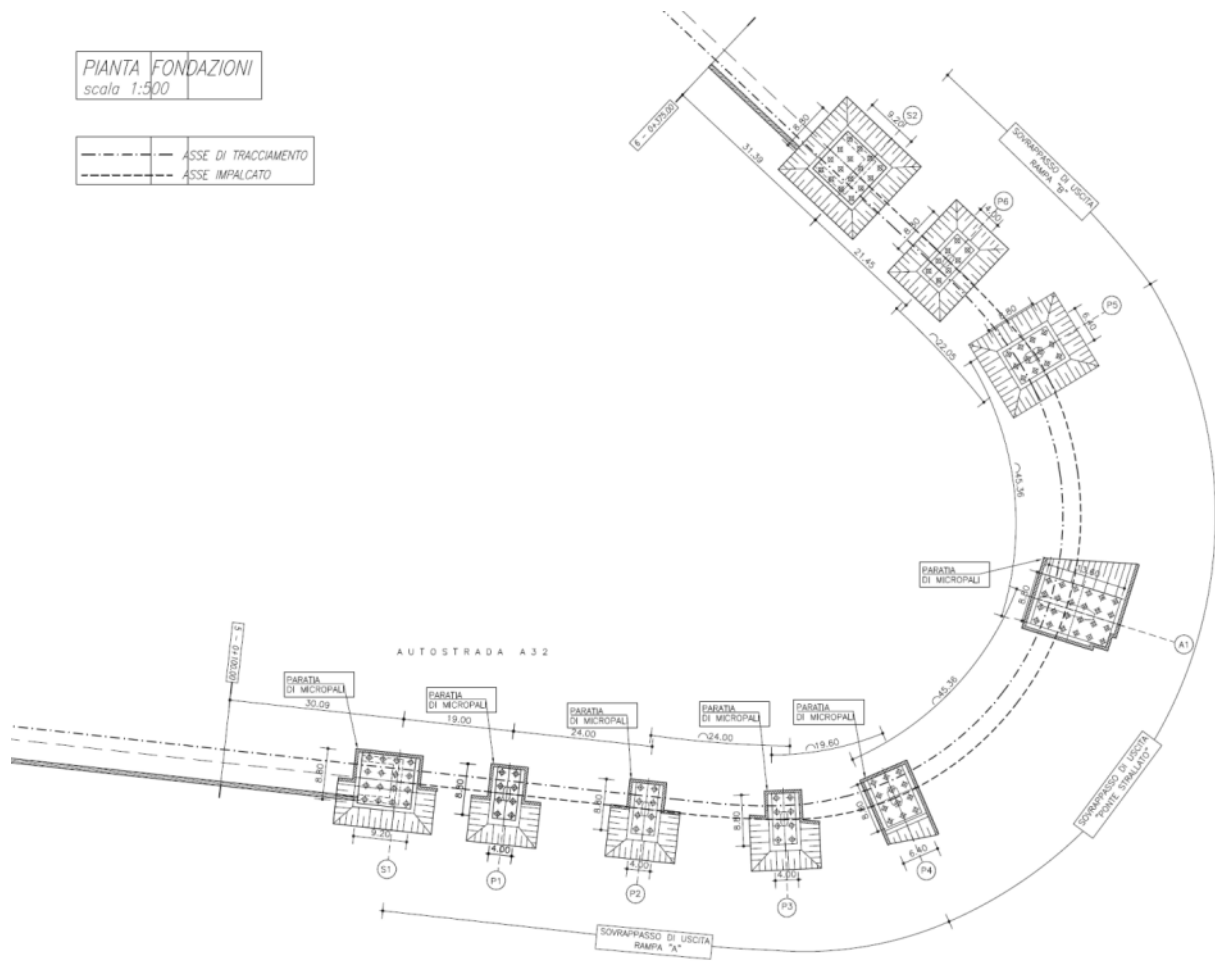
Pianta scavi per sottostrutture sovrappasso d'uscita
